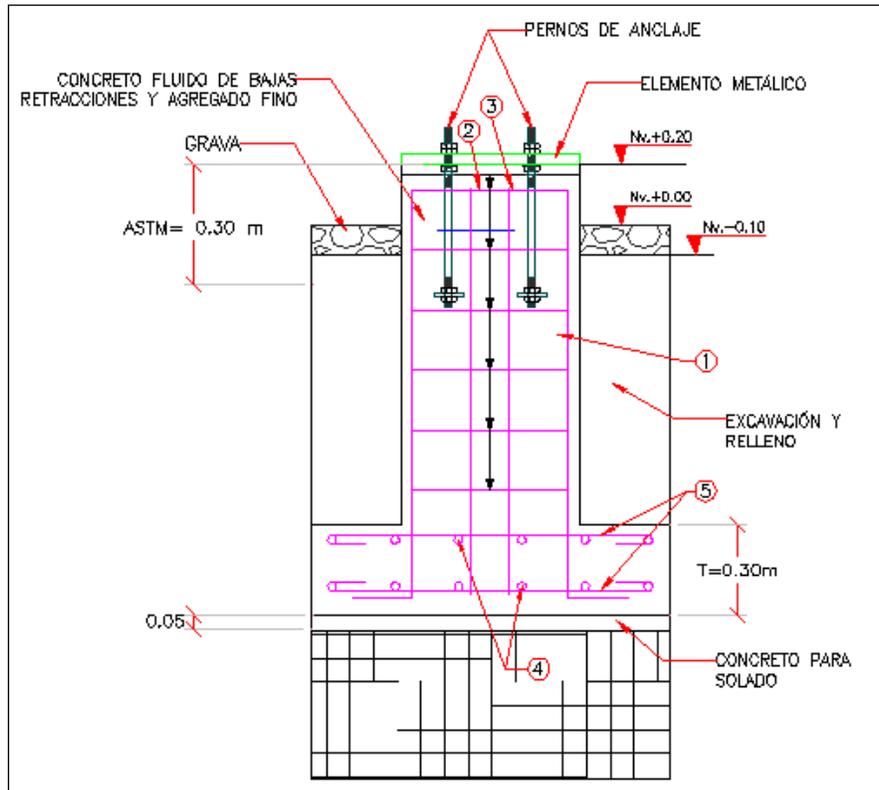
Cimentación soporte de cables mt. vista en corte
